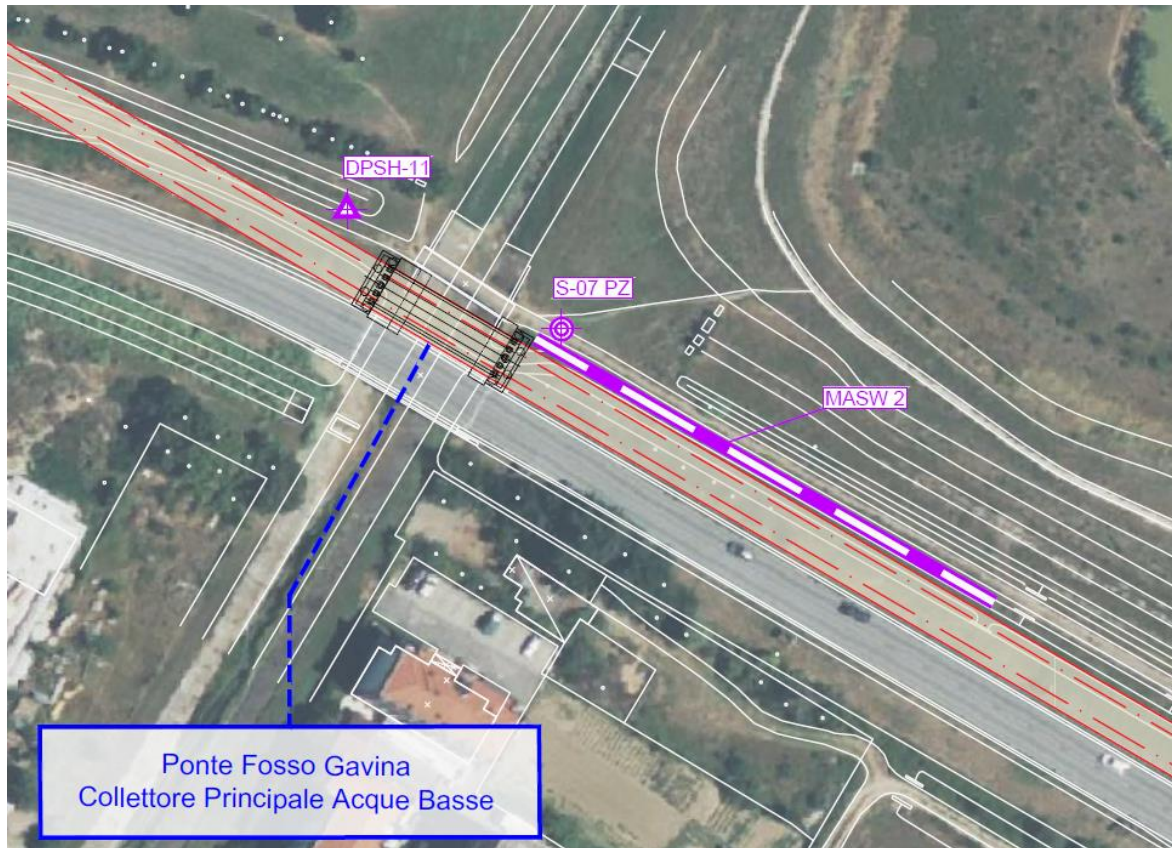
INDIVIDUAZIONE PLANIMETRICA DEL NUOVO PONTE SUL COLLETTORE PRINCIPALE ACQUE BASSE
